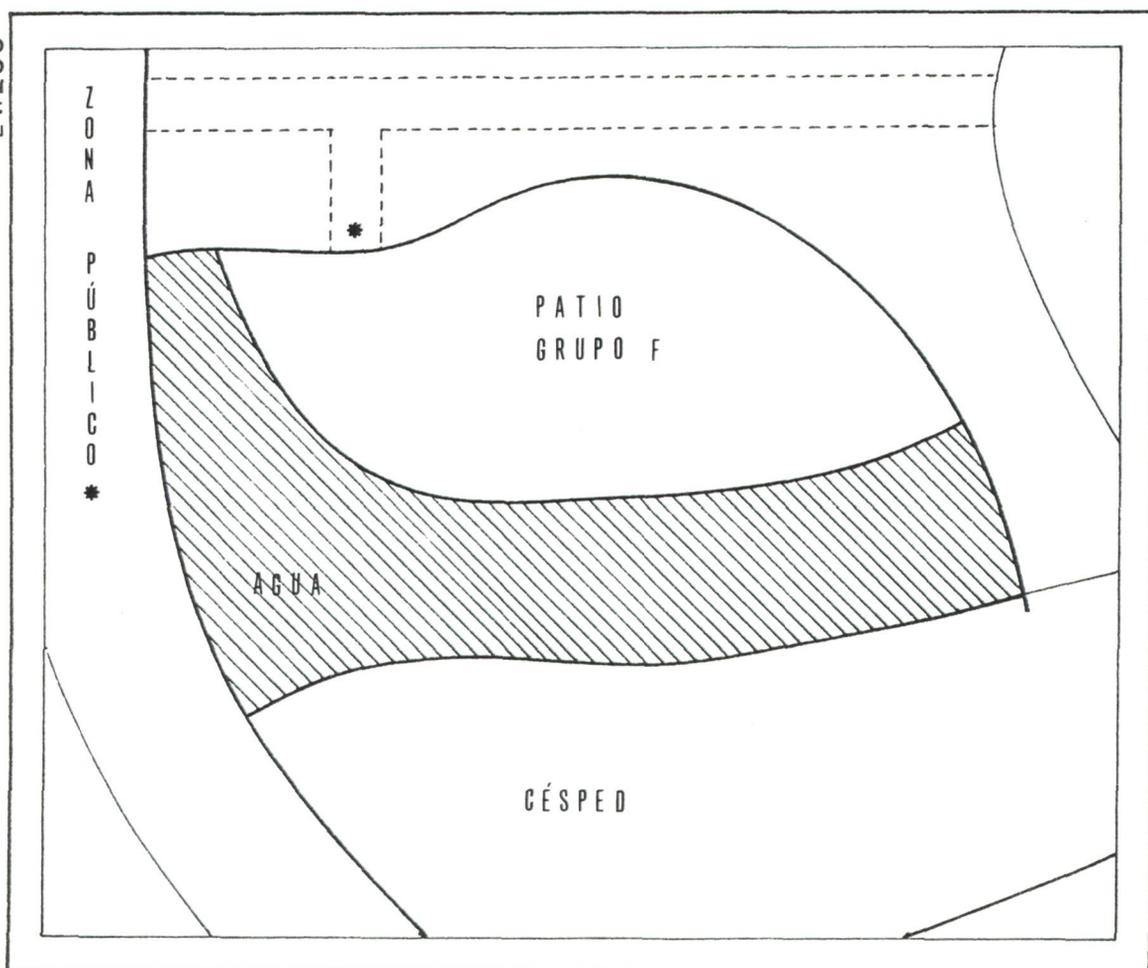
Planta de la instalación exterior del grupo F -la pareja de orangutanes "Mo" y "Boneka"- (Zoo de Barcelona).
